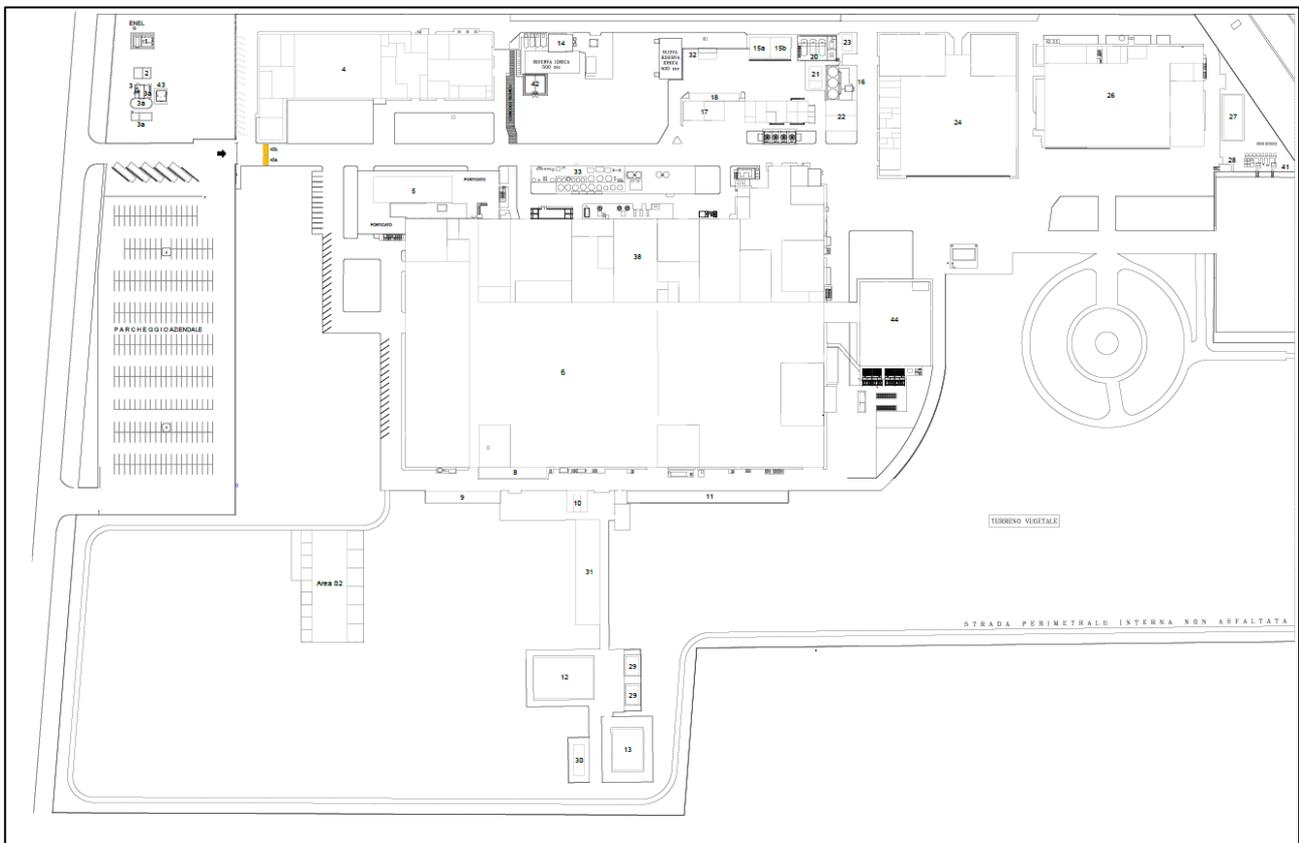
Planimetria stato di fatto Stabilimento di Brindisi
